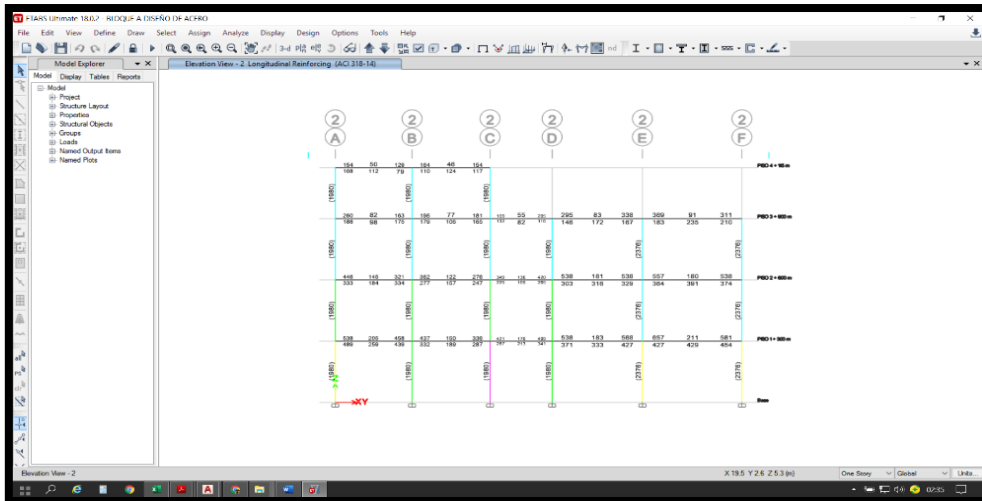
Bloque A - Acero longitudinal en el eje elevación eje 2-2
